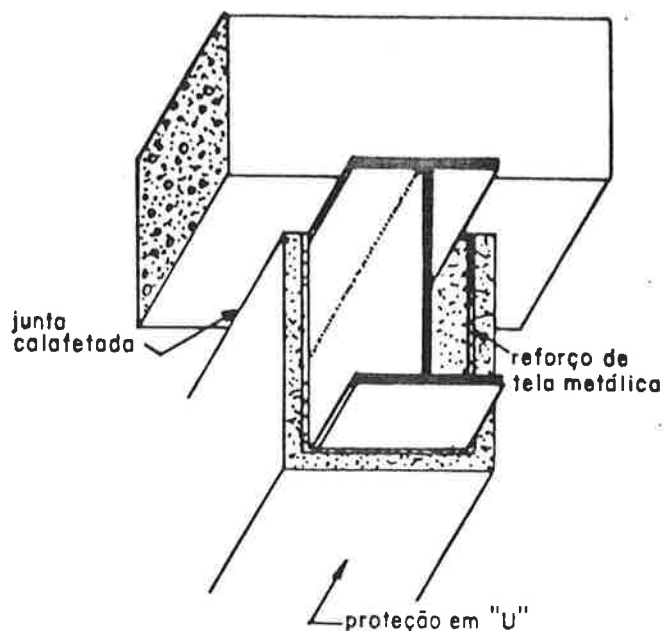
Sistema pré-moldado de proteção para vigas.
